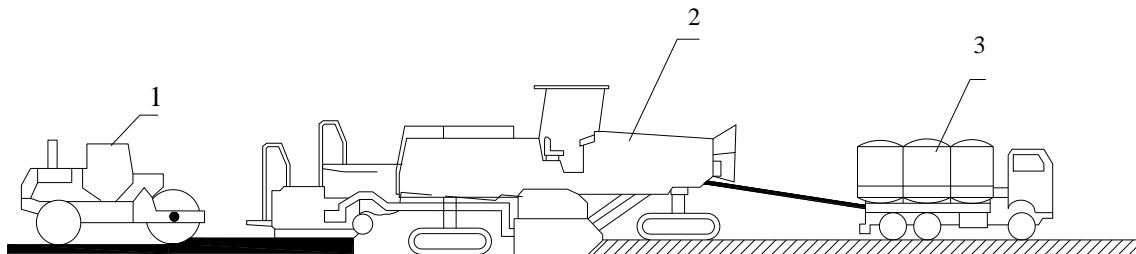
Технологическая схема ХР с использованием в качестве ведущей машины фрезы-регенератора и изготовлением смеси типа Э:
